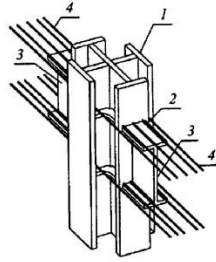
Сварное соединение продольной арматуры и стальных двутавров-вставок: 1 - профиль в колонне; 2 - сварное соединение; 3 — двутавр-вставка; 4 - арматура балки
